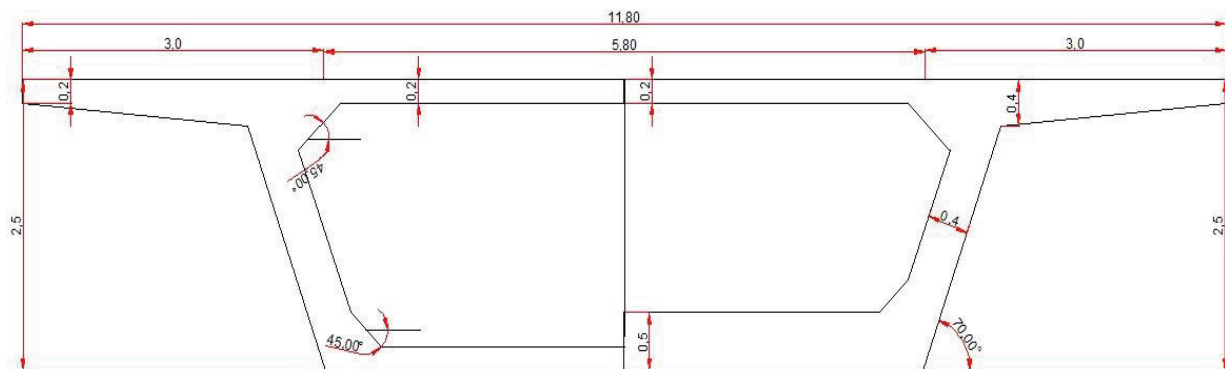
Coupe transversale du voussoir à la clef et sur pile
